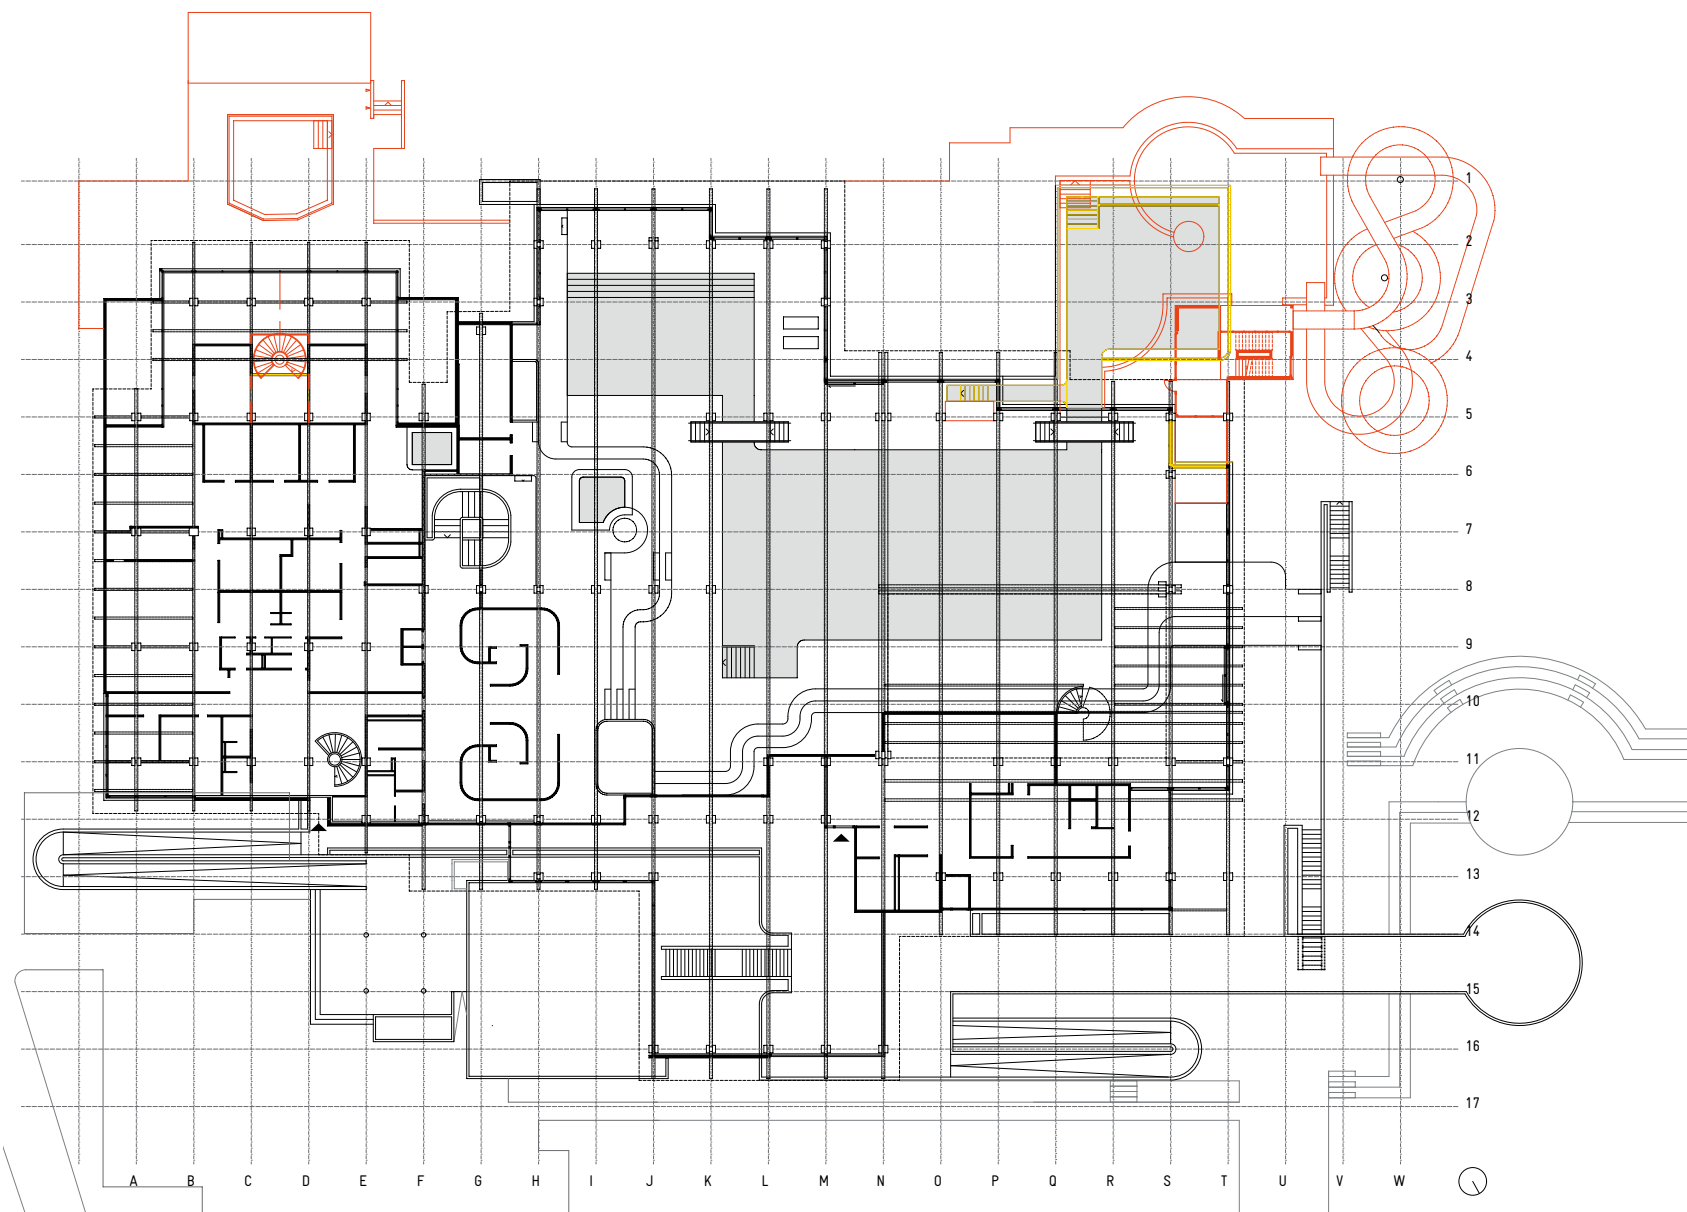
Grundriss Obergeschoß inkl. Umbau Saunenakt und Freibeereich
